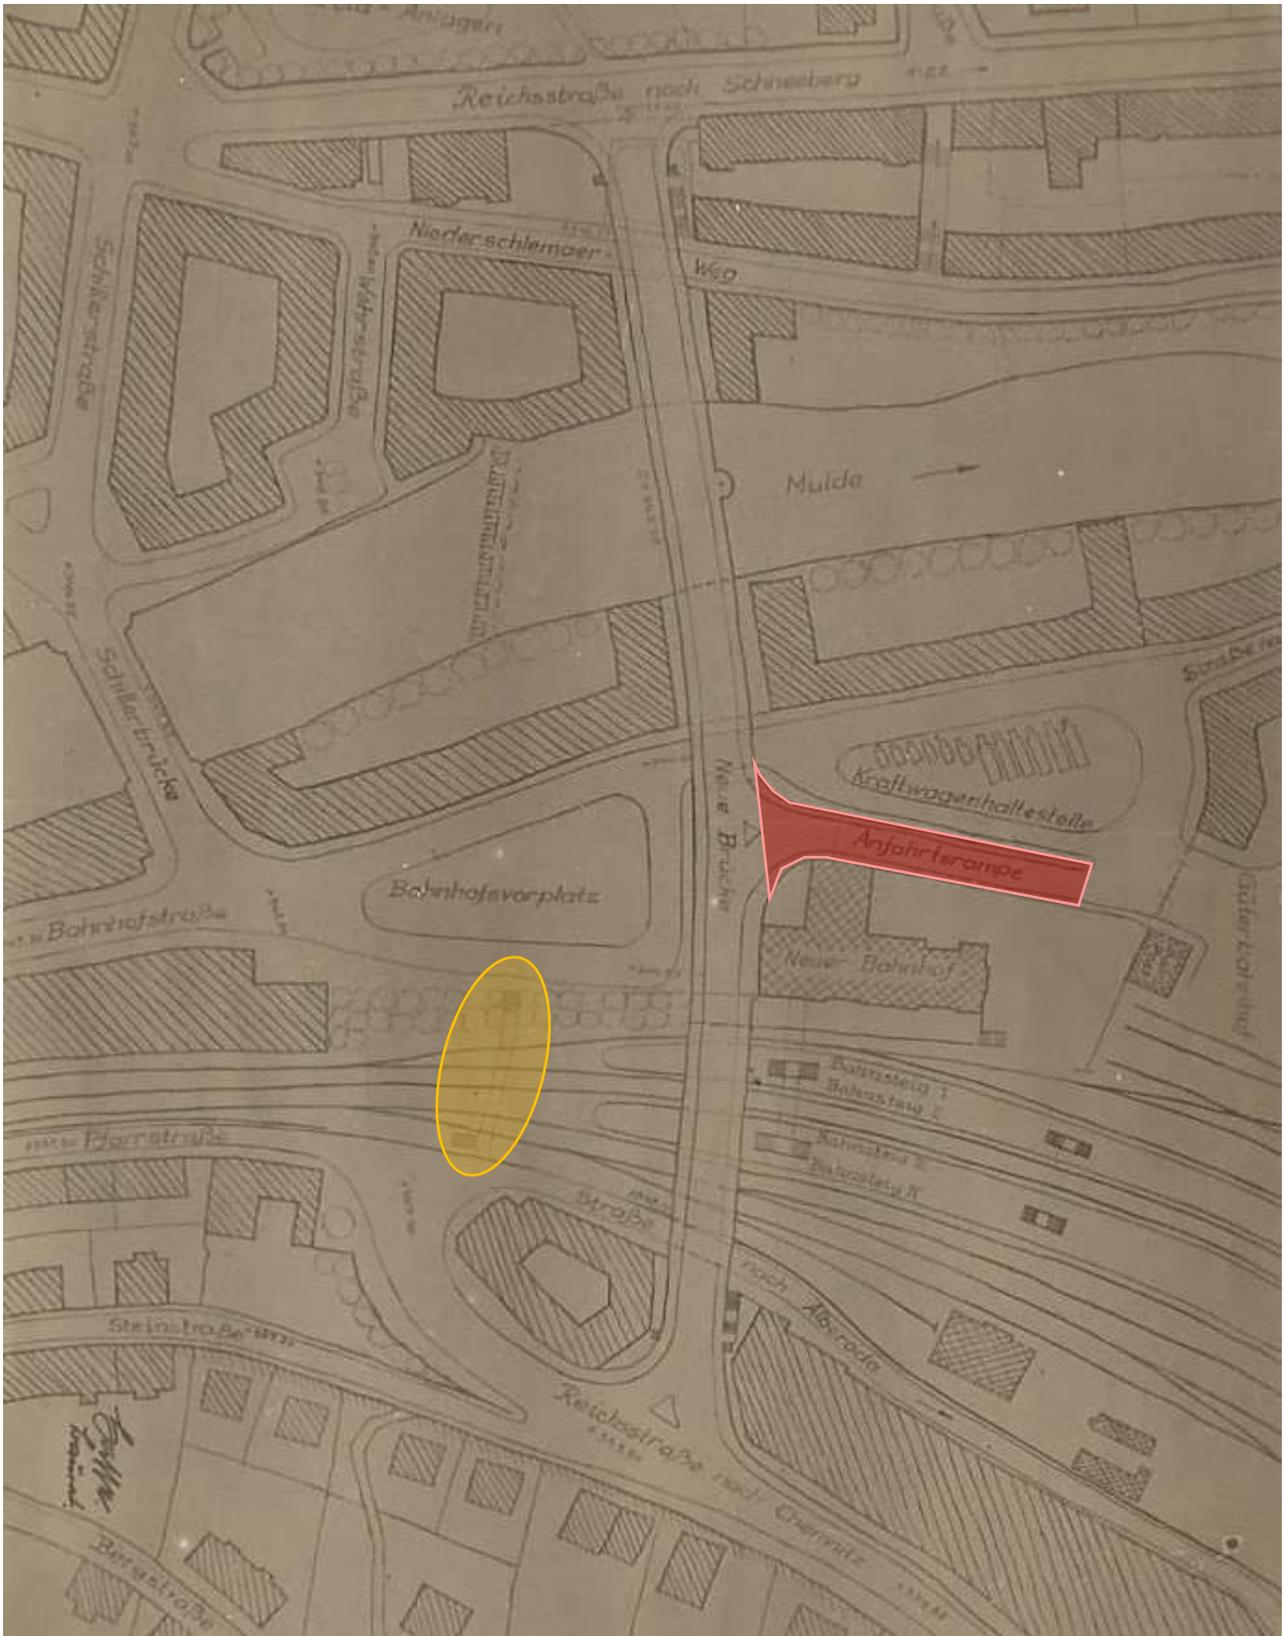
Vorschlag einer Neuen Brücke mit Paraphe des Stadtbaurates Hasse (links unten); Auszug aus „Aue im sächsischen Erzgebirge“
